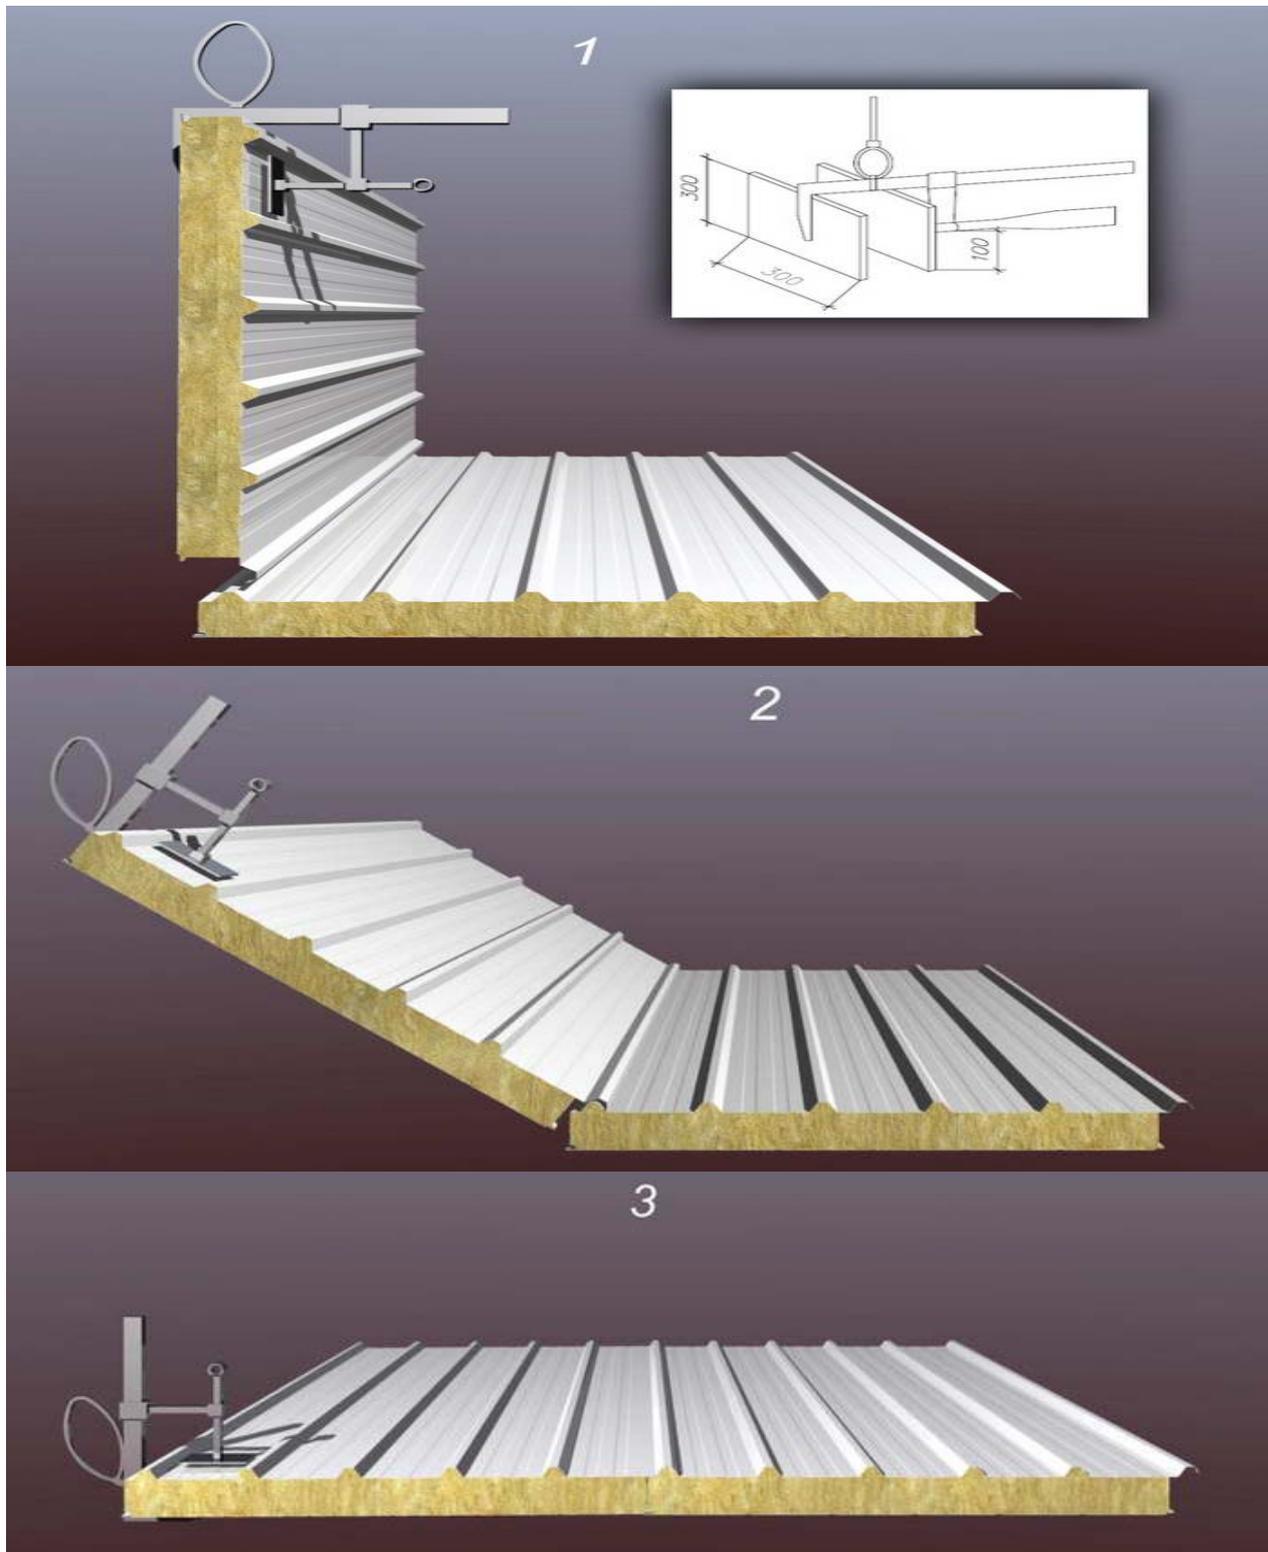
Транспортирование и укладка кровельных панелей на месте монтажа
